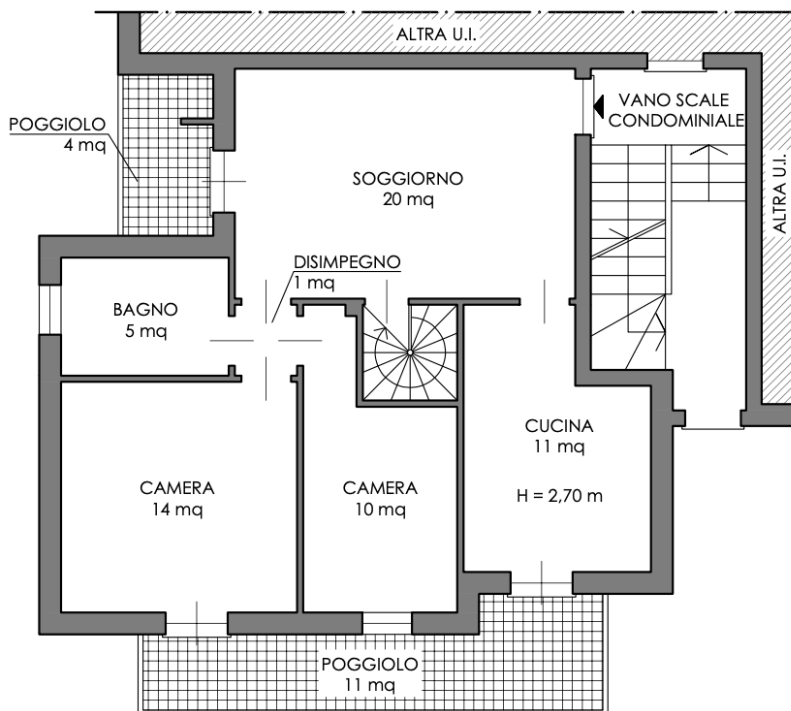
Schema distributivo dello stato di fatto – piano terra.
